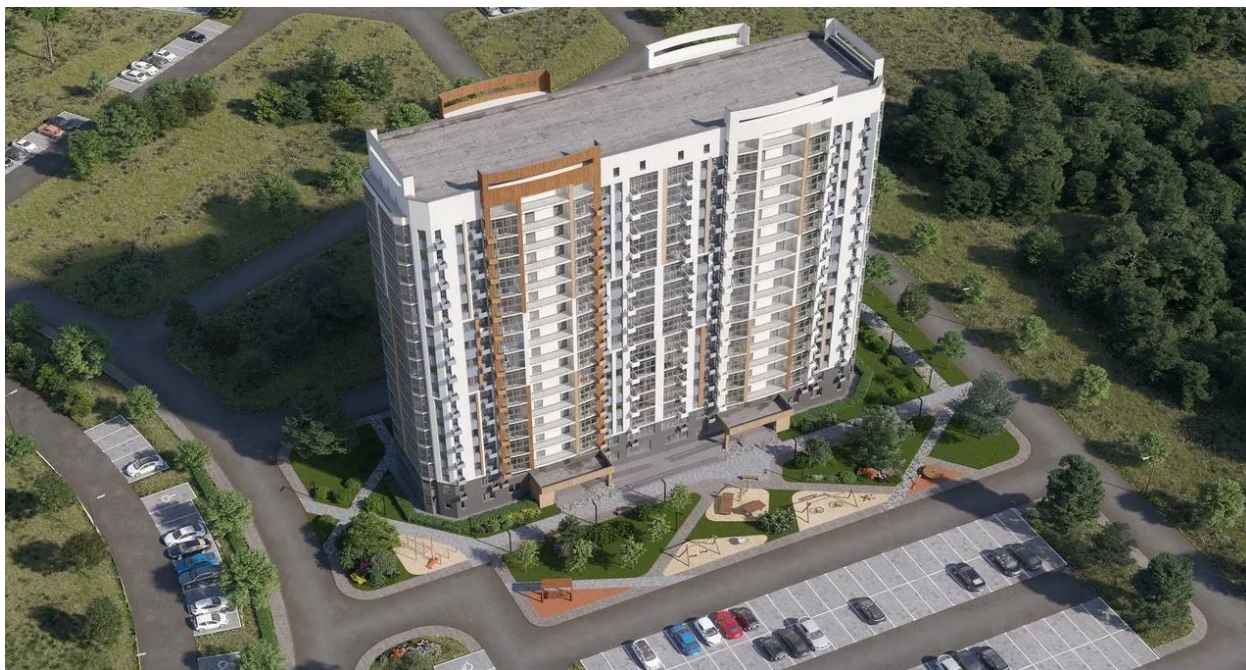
Литер 4а. Архитектурное и фасадное решения
